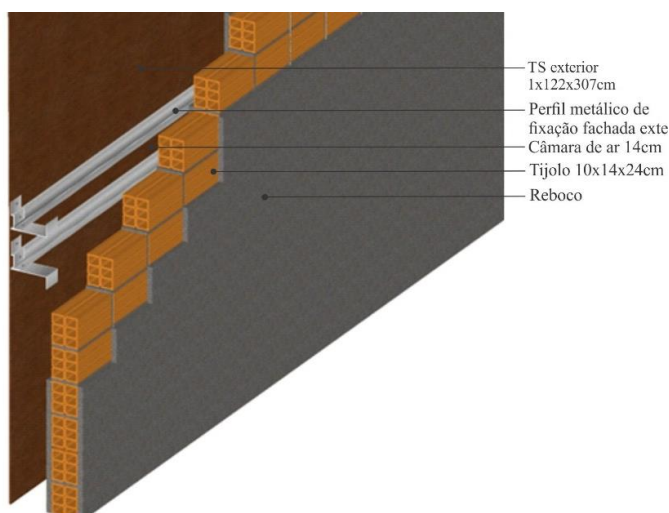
Estrutura da fachada ventilada. (Acervo da autora, 2016)
